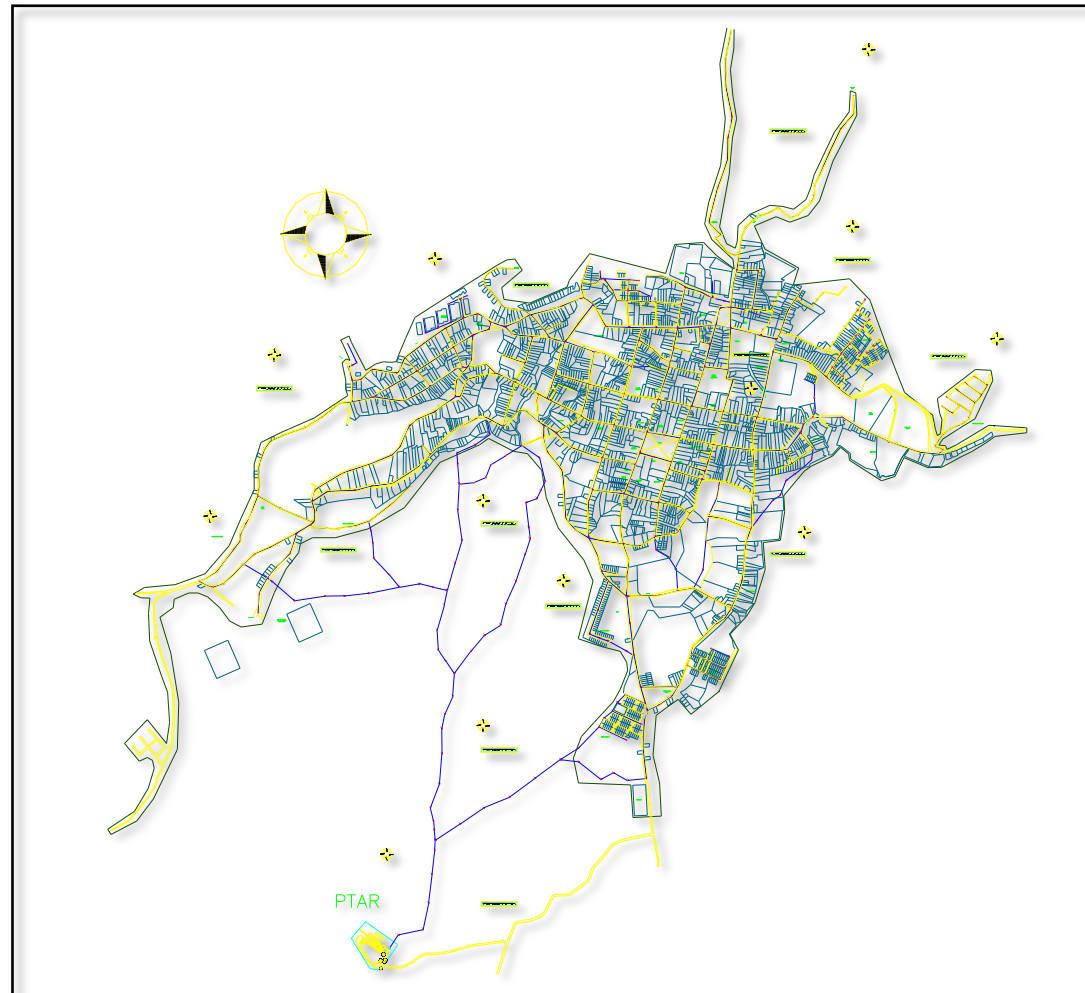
Planta general alcantarillado sanitario de Vélez-Santander.
